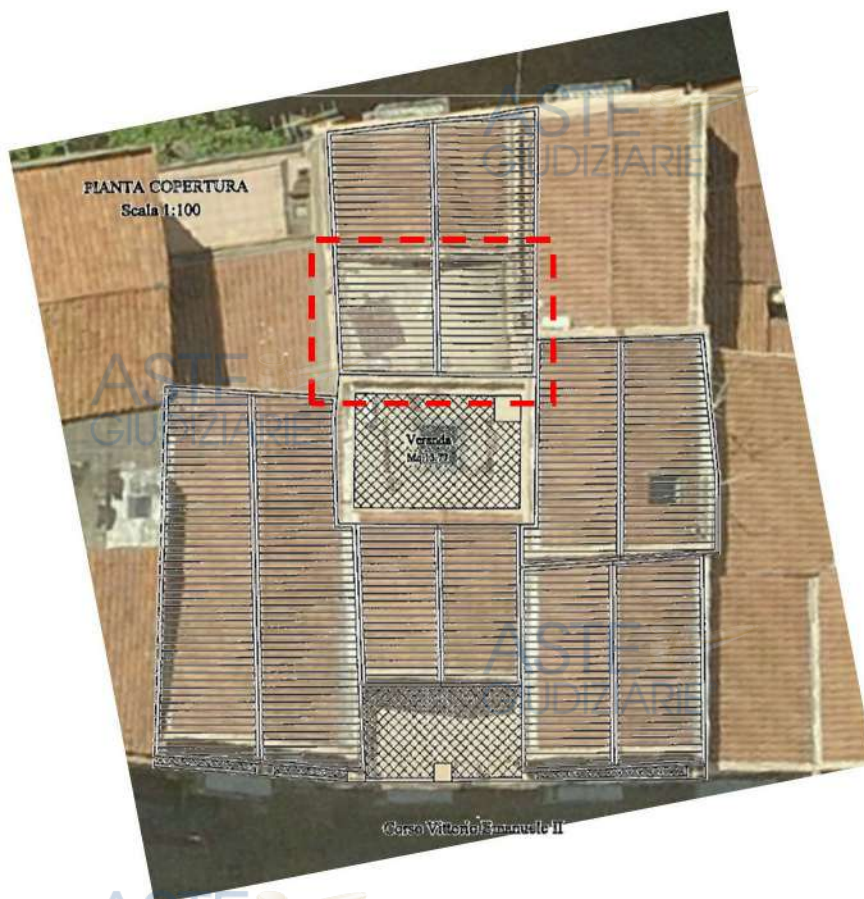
Sovrapposizione ortofoto/progetto approvato. Nord in basso
